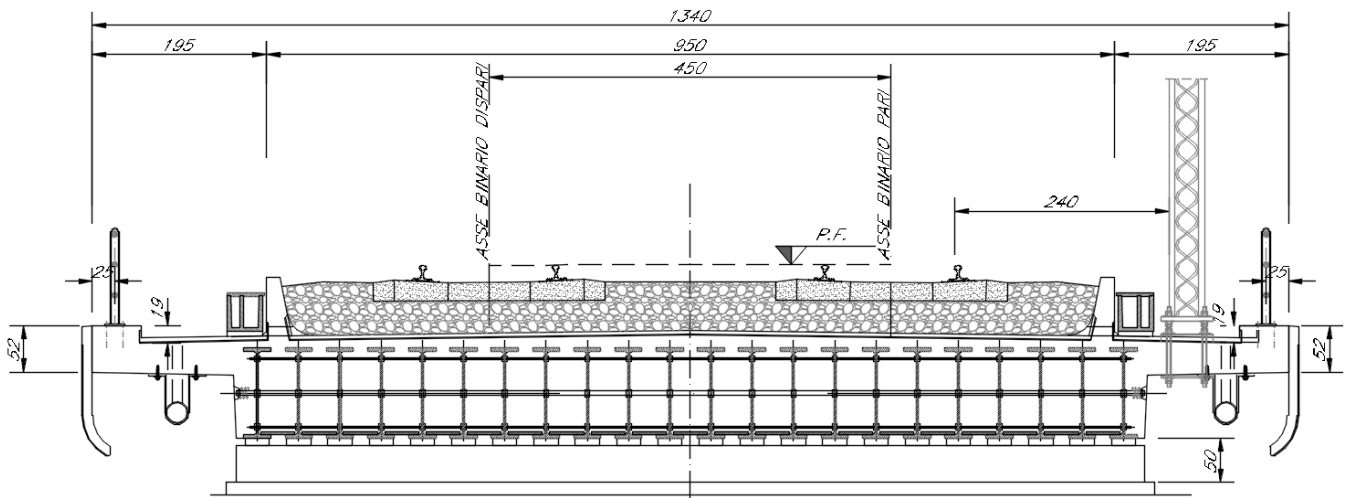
Sezione trasversale dell'impalcato a travi incorporate
